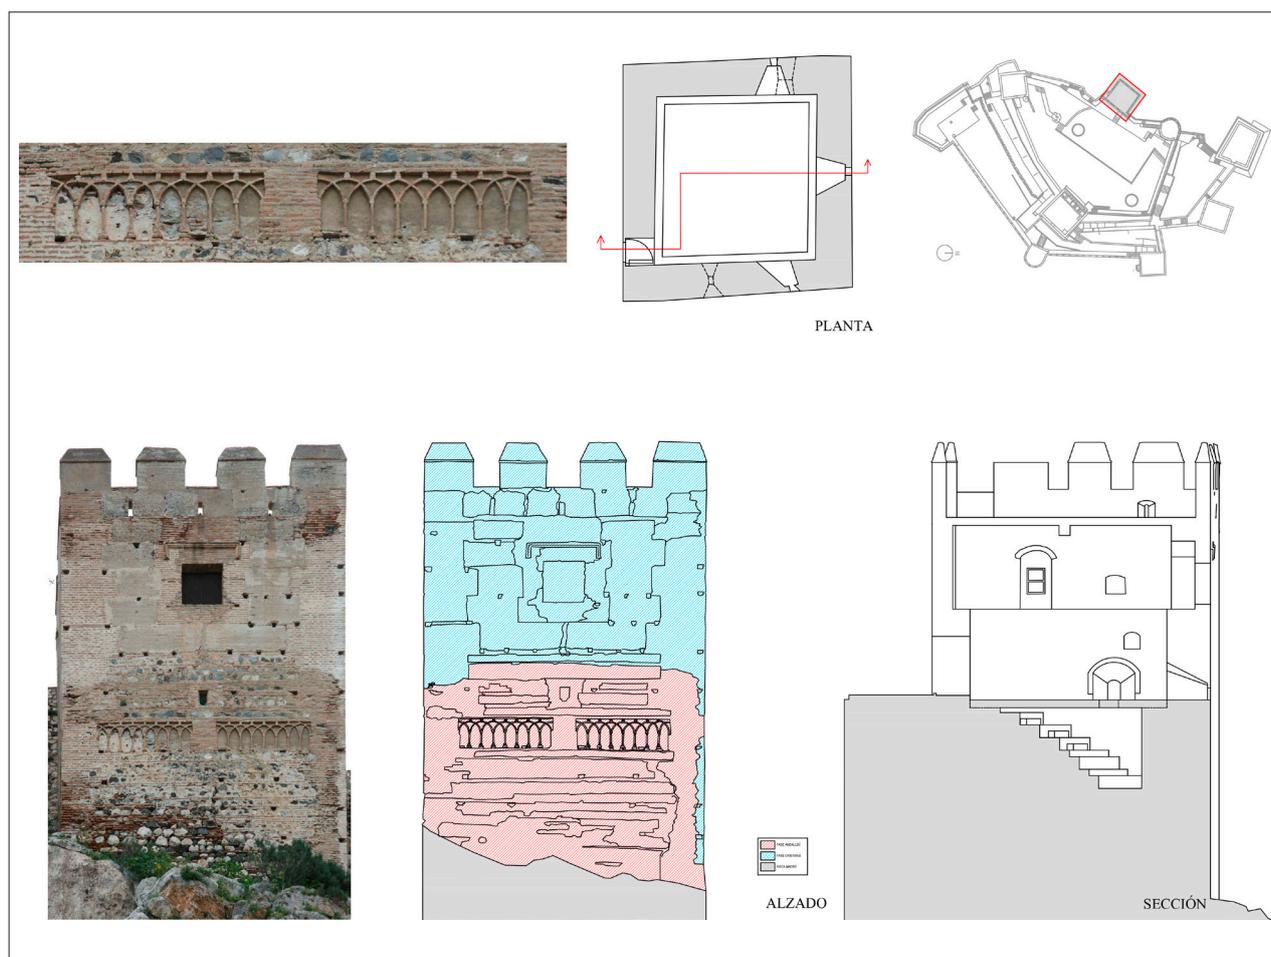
Torre-*qubba* del palacio de Salobreña: planta, alzado y sección. Planimetría: Antonio Orihuela y Antonio Almagro, Proyecto de Restauración del Castillo de Salobreña, 2012.
